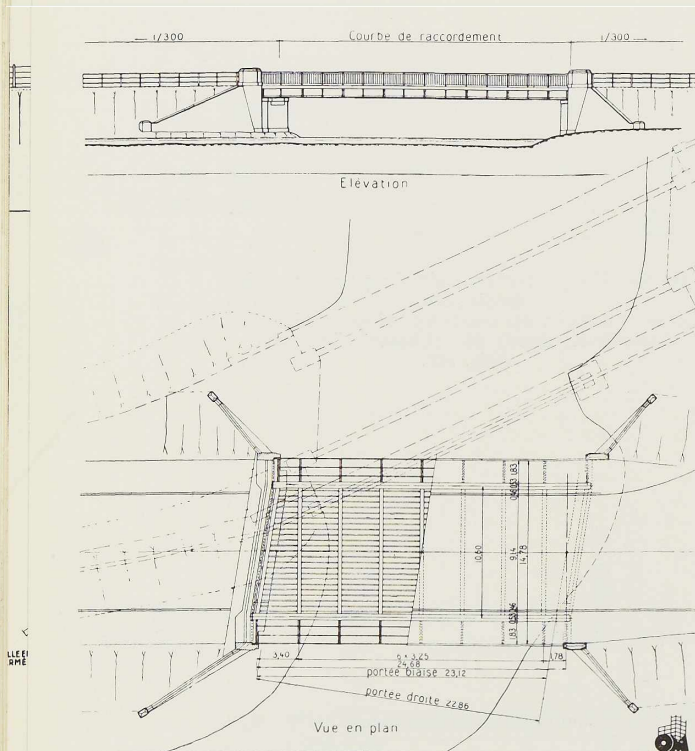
Elévation et vue en plan d'un pont à poutres à âme pleine encadrant le tablier. Elevation and plan of a through plate girder bridge.
